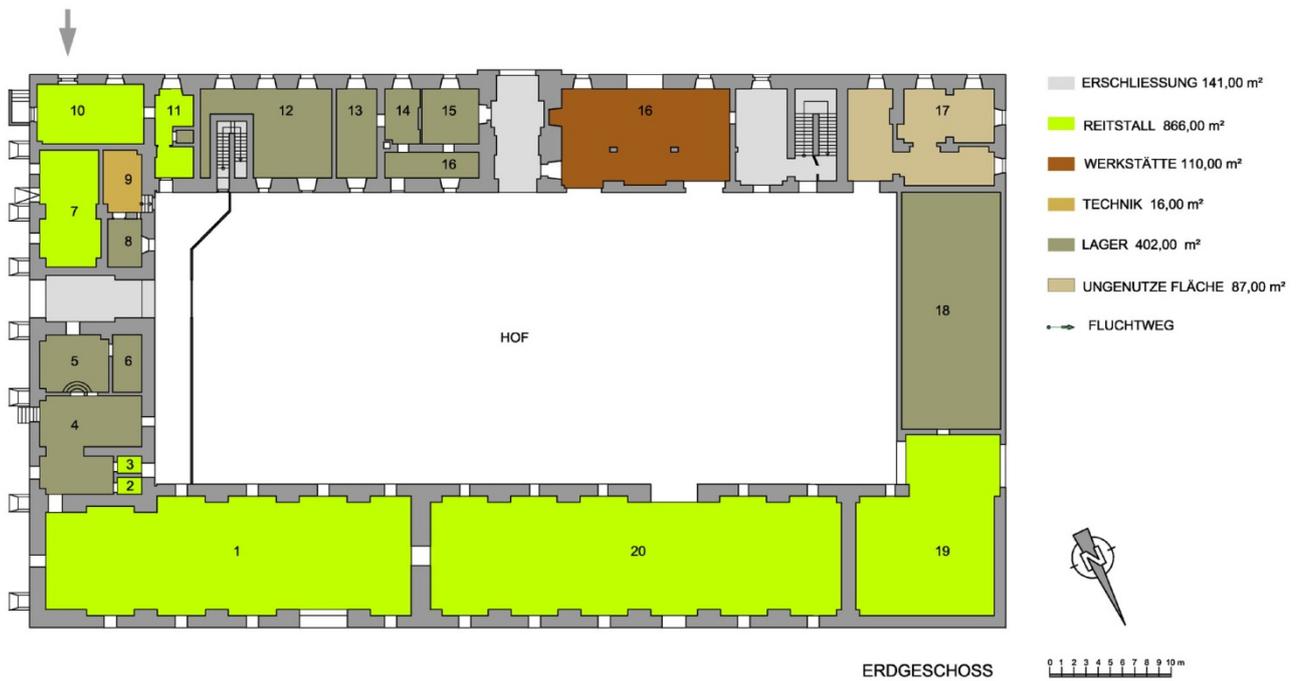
zeigt den Grundriss des Schlosses Niederabsdorf
